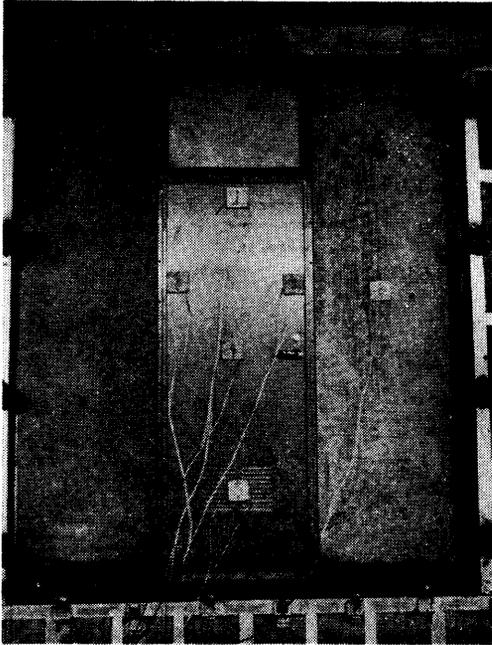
B級仕切用スチールサッシュ扉試験体 (Specimen 23)
